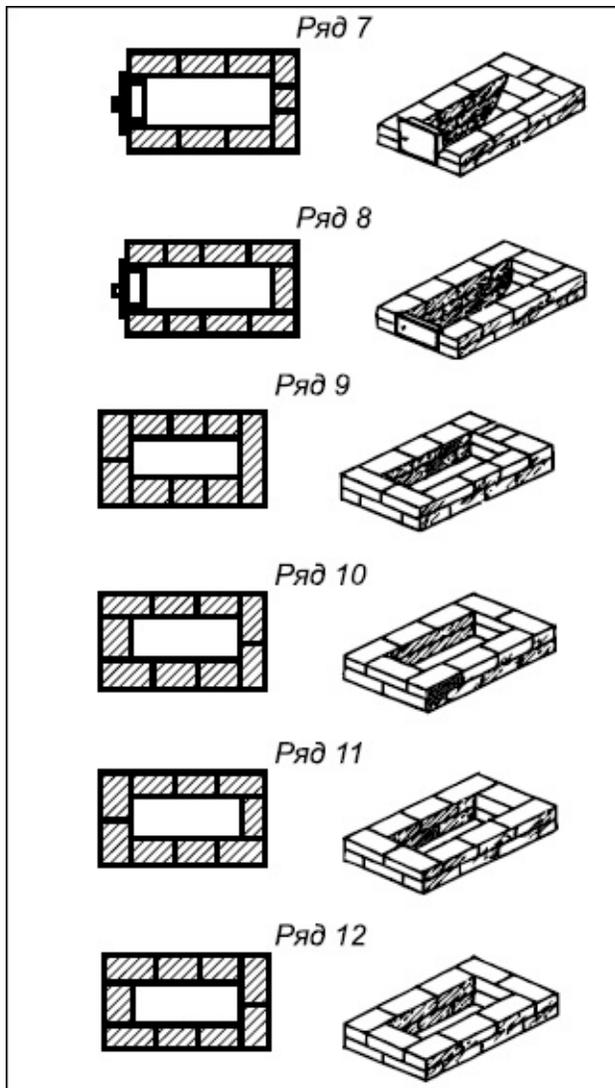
(продолжение). Кладка отопительной прямоугольной печи
